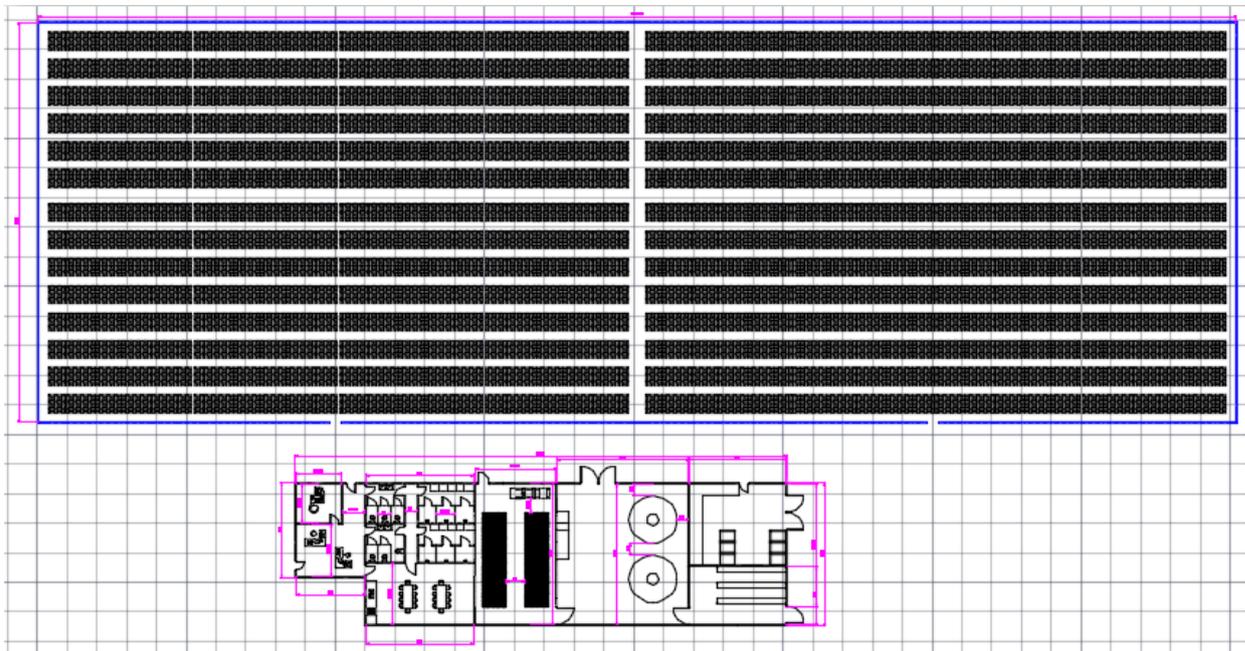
Plano total de planta. Fuente: Elaboración propia.
